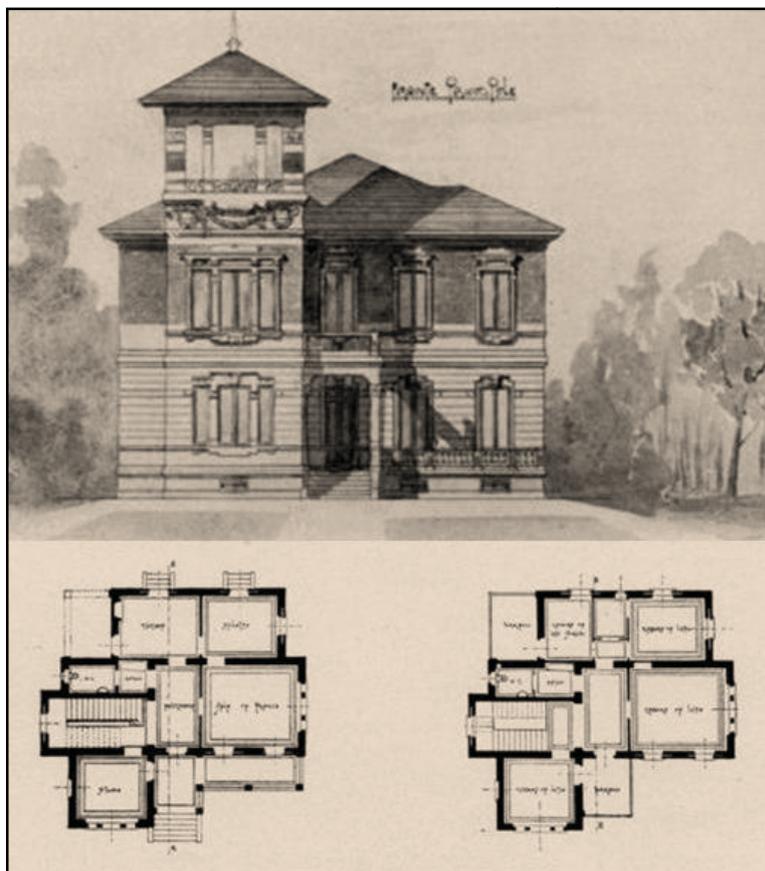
Casa, projeto de Antonio Sant'Elia: plantas baixas e fachadas.
